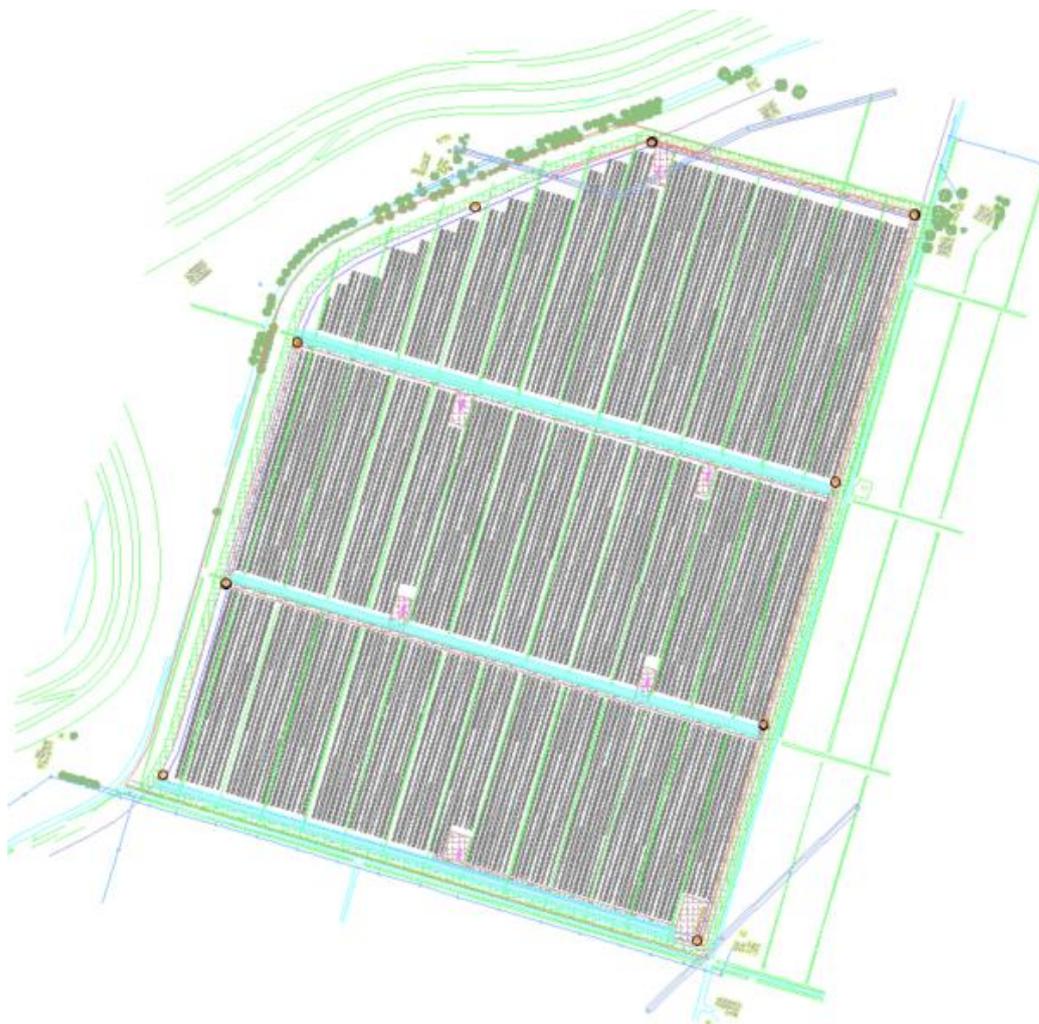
Configurazione sezione Nord dell'impianto agrivoltaico
